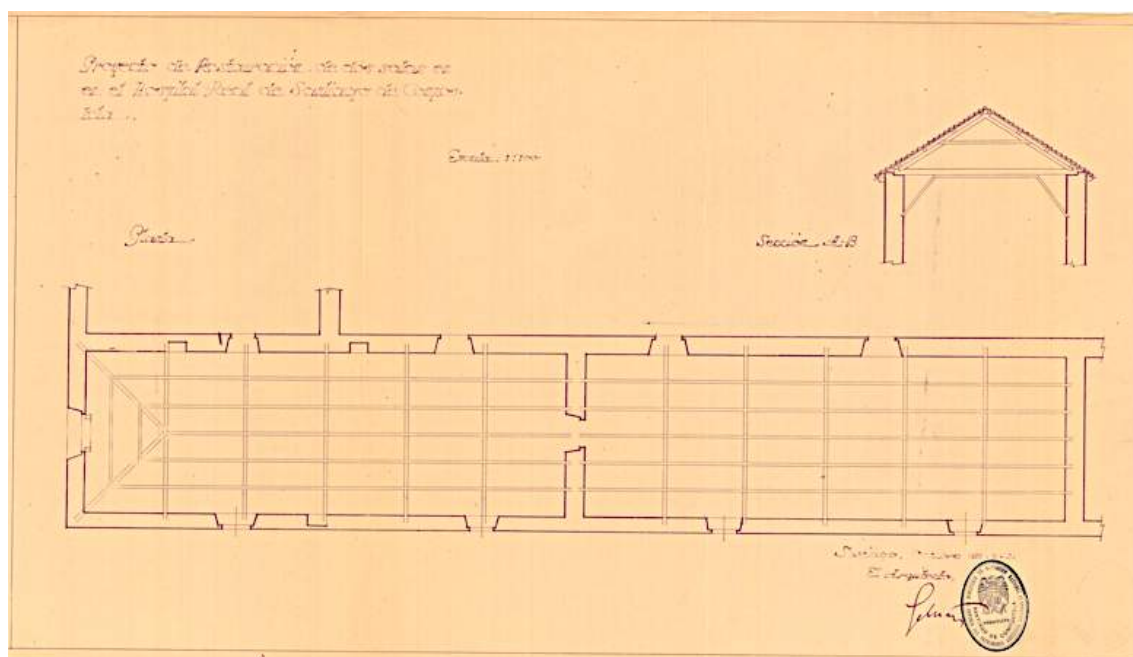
Planta y sección del Proyecto de obras de restauración de dos salas, 1943.
